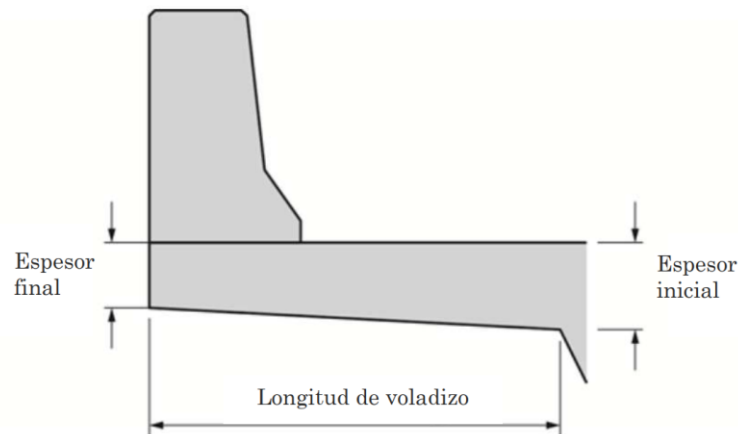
Sección transversal de voladizo de viga cajón (Fuente: [12]).
